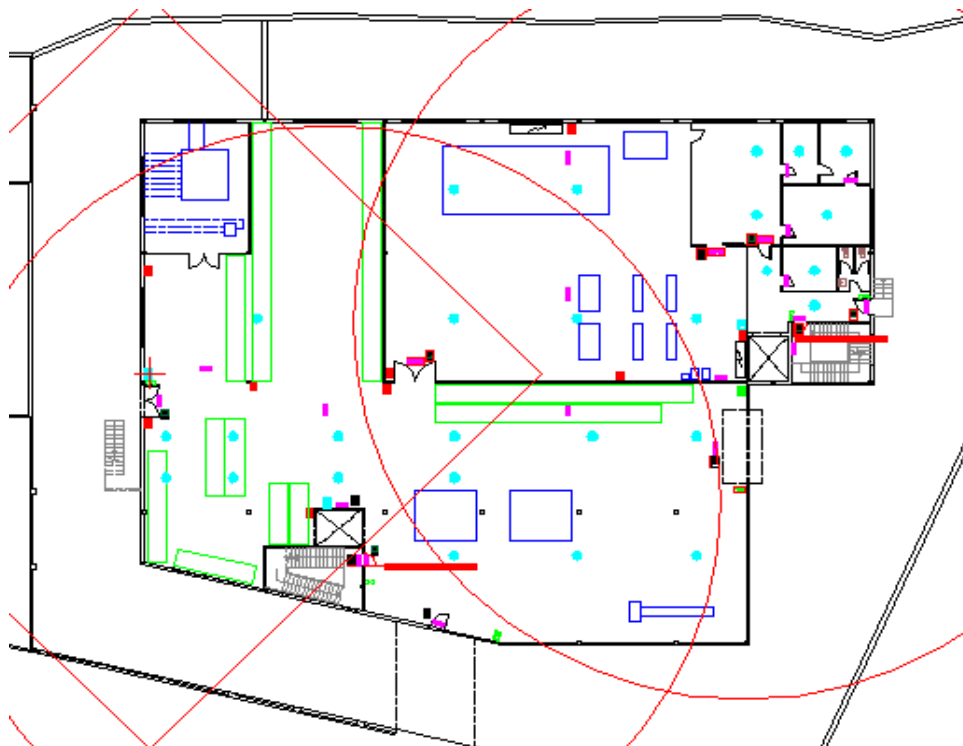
Superficie cubierta por las BIE's en la planta baja del edificio Almacén
